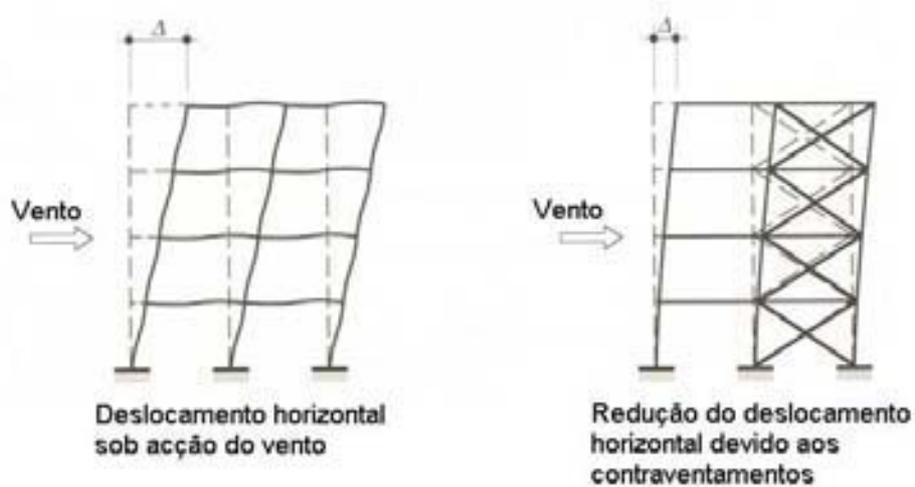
Esquema de pórtico metálico contraventado de formas diversas
